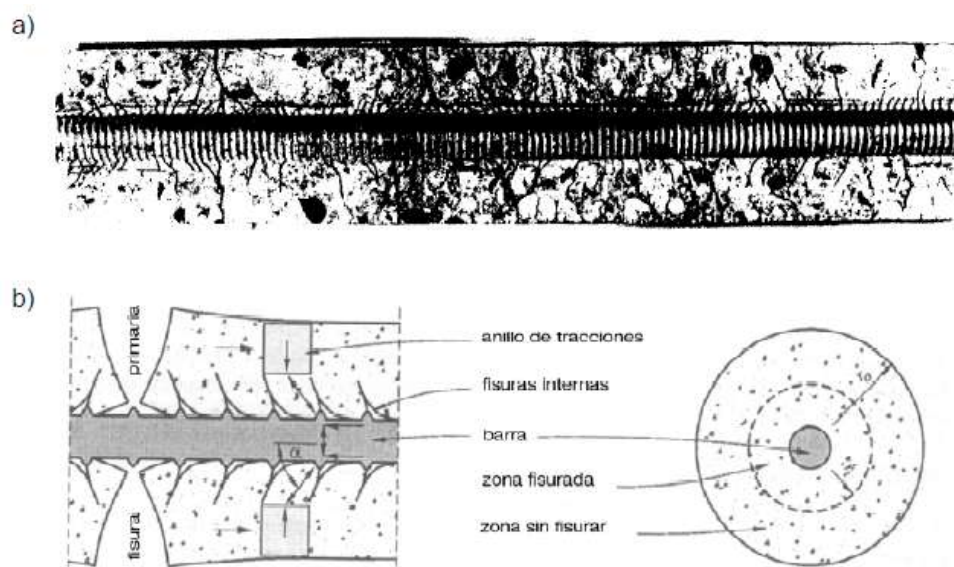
a) Fisuras primarias y secundarias alrededor de una barra de acero, b) Mecanismo de fisuración alrededor de la barra luego de formadas las fisuras internas (Goto, 1971)
